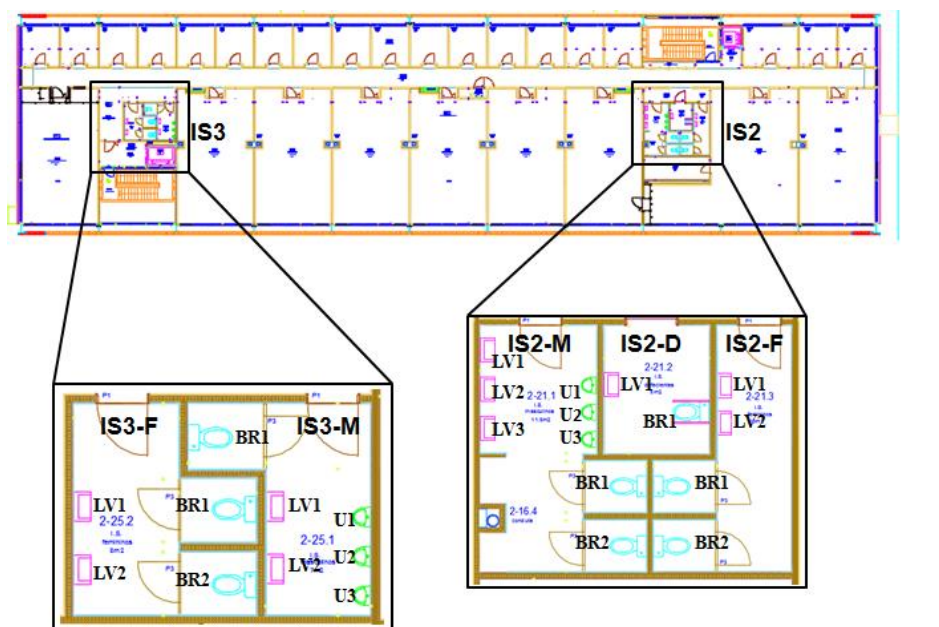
Planta Piso 2 - Localização das Instalações Sanitárias IS2 e IS3 e dos respetivos dispositivos de utilização.
